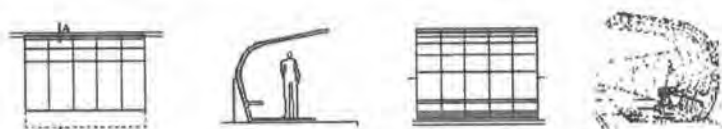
Planta baixa, corte, elevação e perspectiva de abrigo tipo B.
